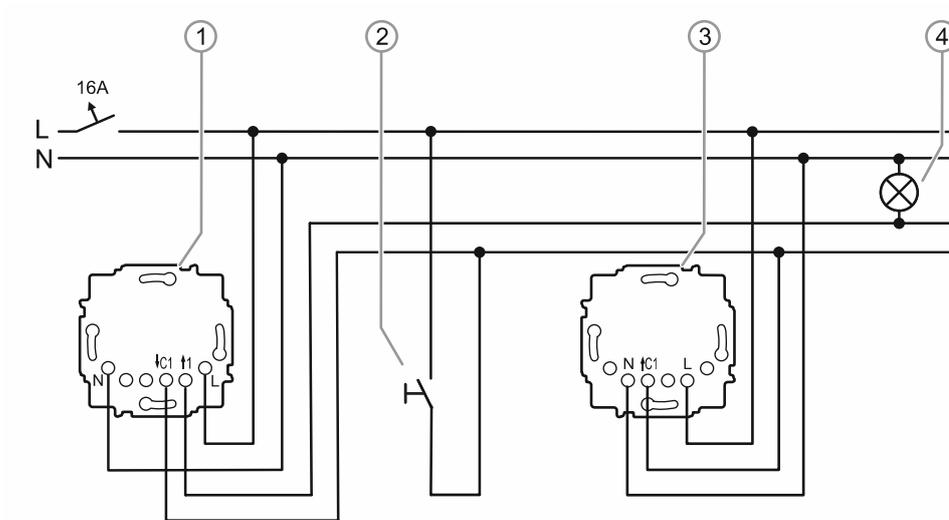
Exemple d'application : cage d'escalier avec capteur à lentille multiple – Raccordement
